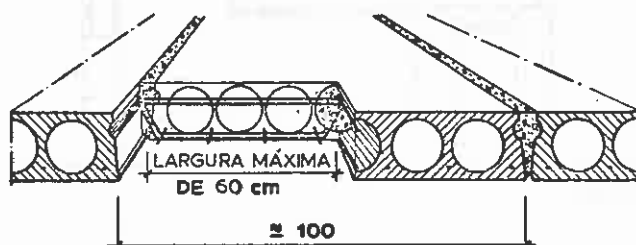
Pormenor de realização de abertura em pranchas vazadas (18)
